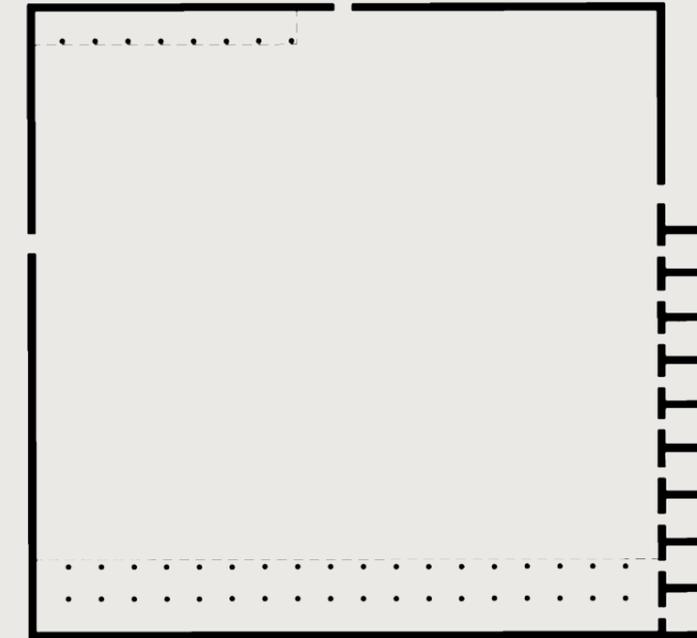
Reconstrução esquemática da Casa do Profeta, Medina. Fonte: Khan Academy.
